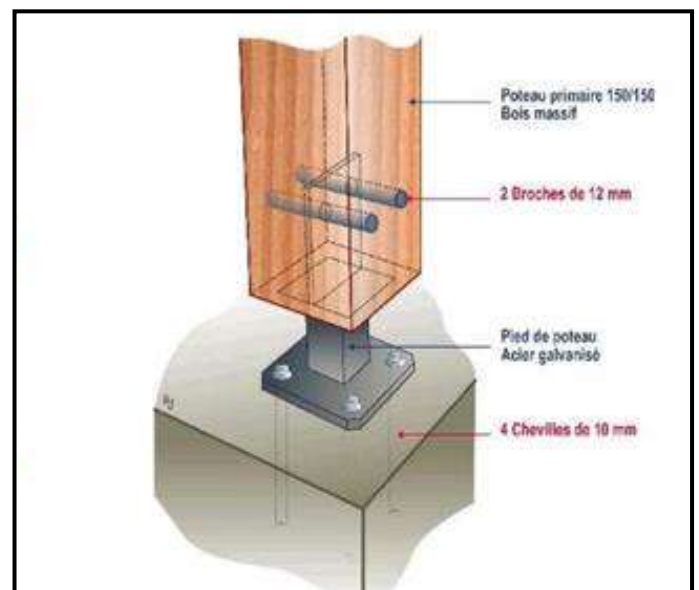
Assemblage poteau en bois + soubassement en béton armé
